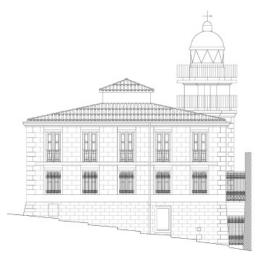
Alzado oeste. Proyecto de restauración 2015 M.J. Balaguer
